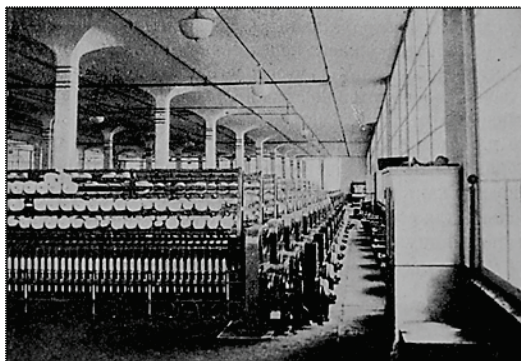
Detalhes do desenvolvimento do sistema de lajes sem vigas
